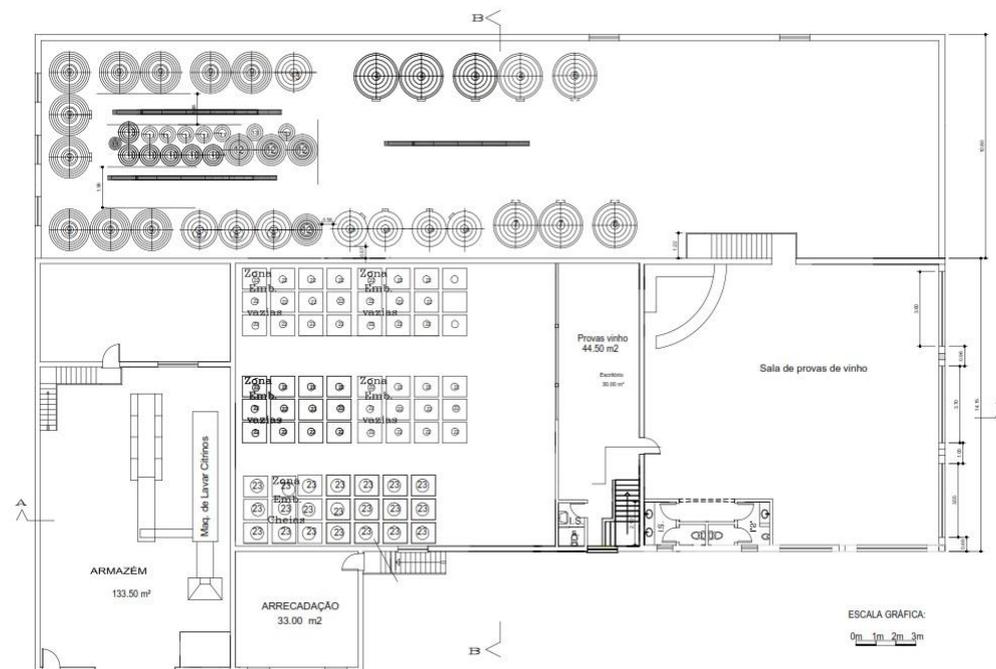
Adega Quinta da Vinha – Planta do Piso 1⁵⁵
